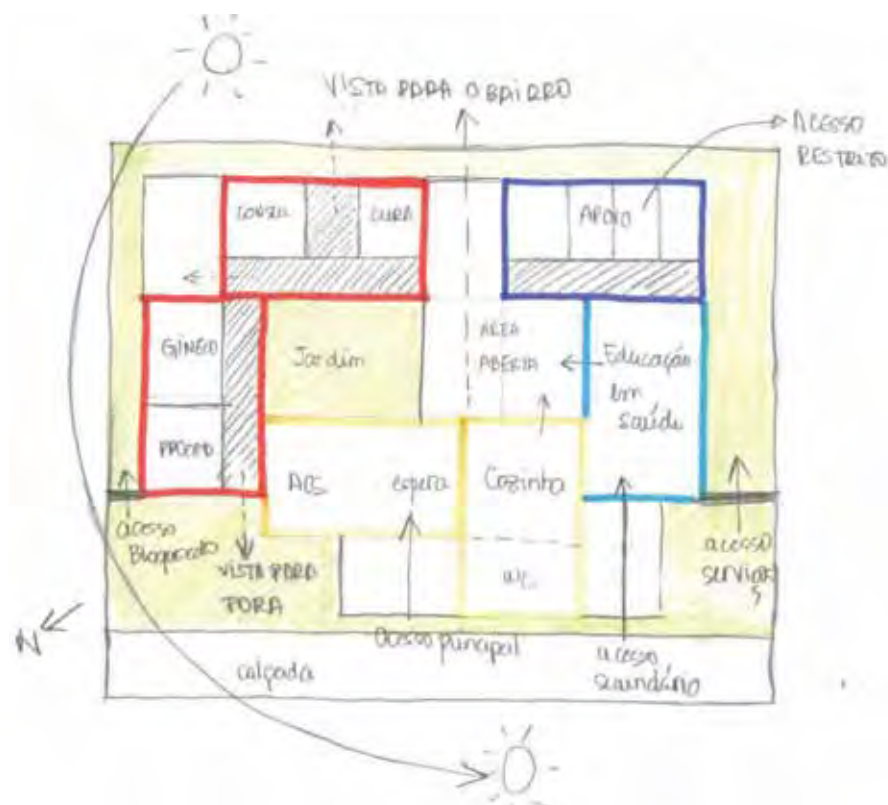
Planta baixa com as áreas de circulação pela unidade. Acesso ao espaço de apoio (em azul) é restrito. Atendimento clínico (em vermelho) fica mais protegido da insolação.
